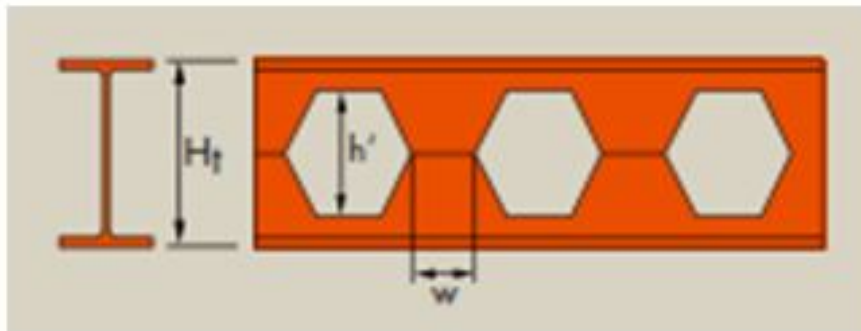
Viga de alma aligerada, viga tipo Boyd
